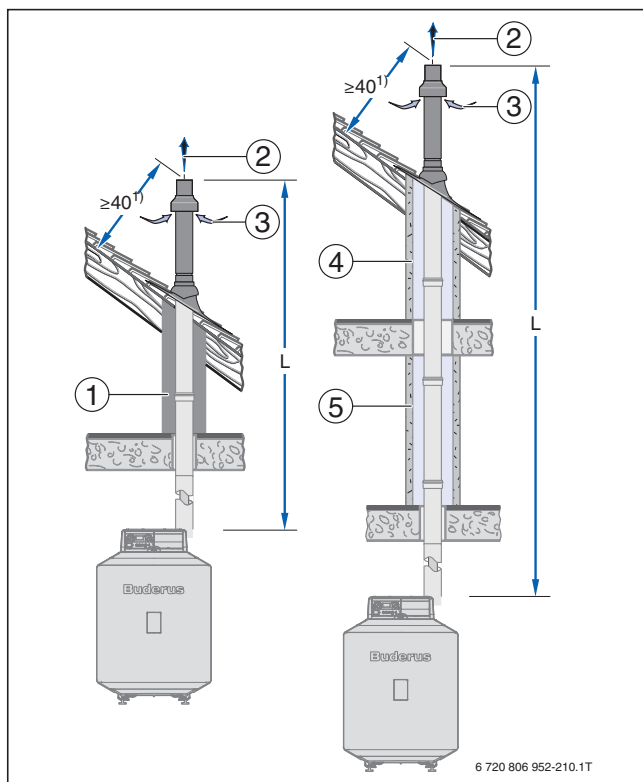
Montagevarianten mit Bausatz DO (Maße in cm)
